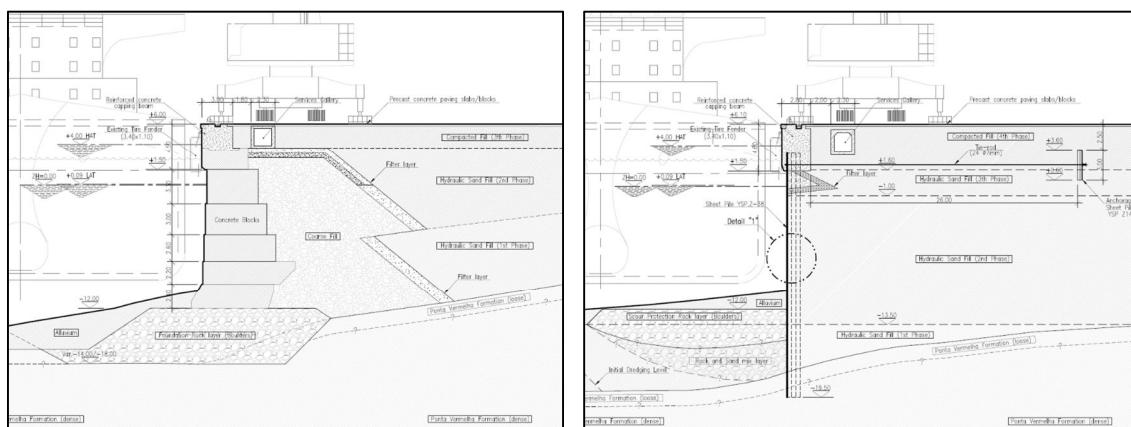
Estrutura existente: Cais tipo "J" e "L" respetivamente
